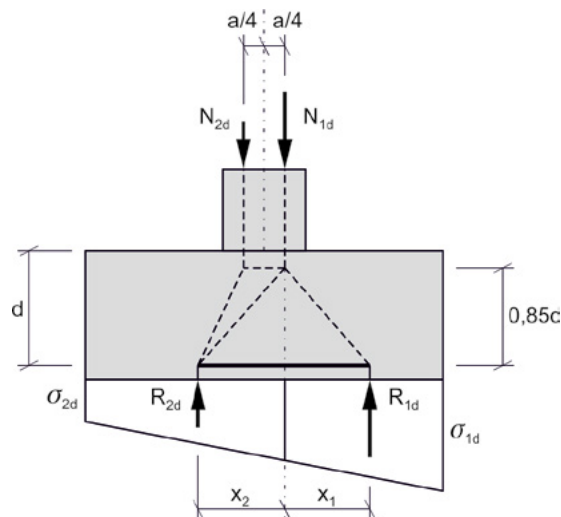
Modelo de bielas y tirantes planteado para el dimensionamiento estructural de la zapata
